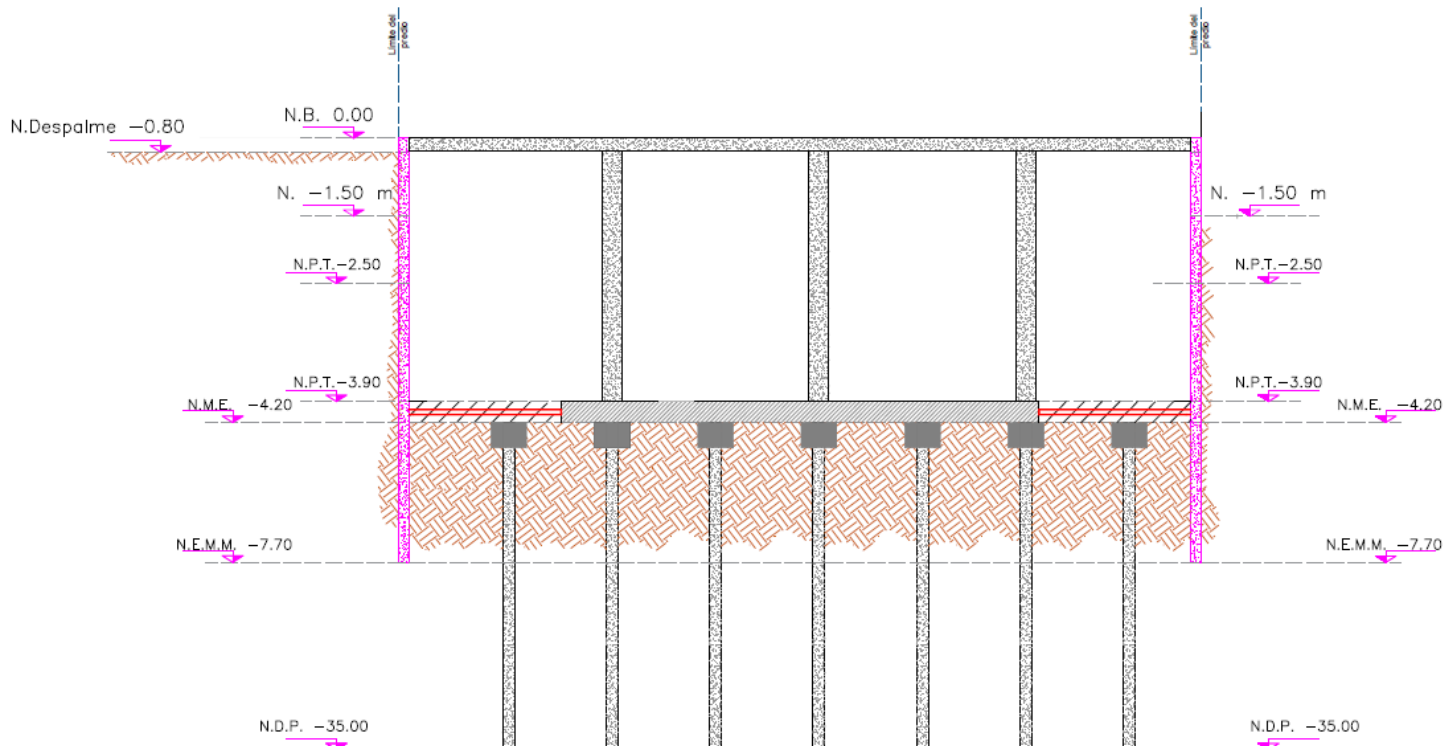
CONSTRUCCIÓN DE ESTRUCTURA CENTRAL
